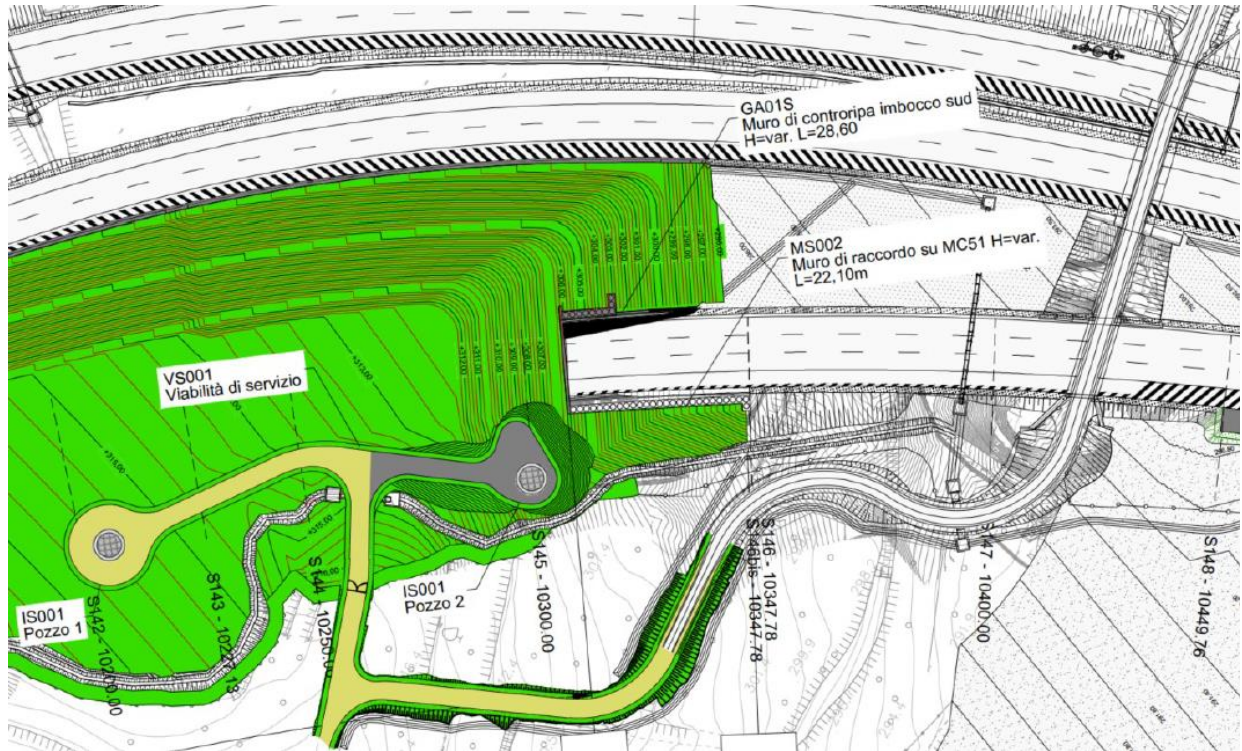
Viabilità di accesso per la manutenzione del sistema di drenaggio e del verde: in ocra la pavimentazione permeabile con pendenze più dolci in misto granulare; in grigio la pavimentazione impermeabile a finitura bituminosa col piazzale di manovra per l'accesso al pozzo 2.
